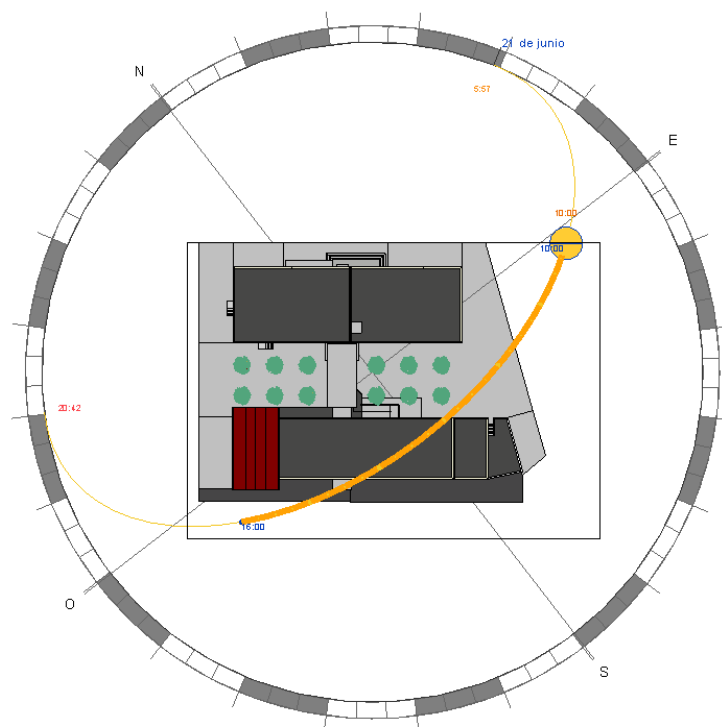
Vista en planta con camino de sol activado con norte real
